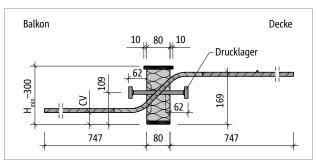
Schöck Isokorb® T Typ QP-V8 bis QP-V9: Produktschnitt
